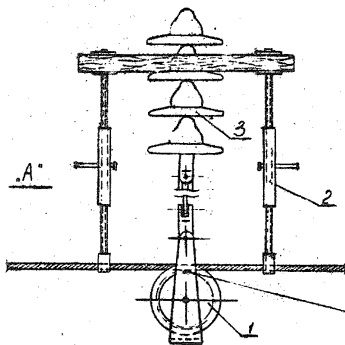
Узел „А“ Крепление монтажной лестницы
